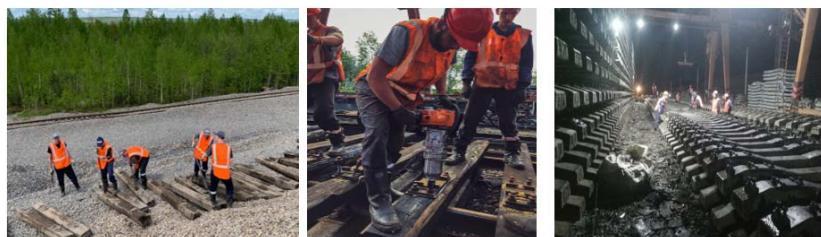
Демонтаж и монтаж рельсошпальной решетки на деревянных и железобетонных шпалах
